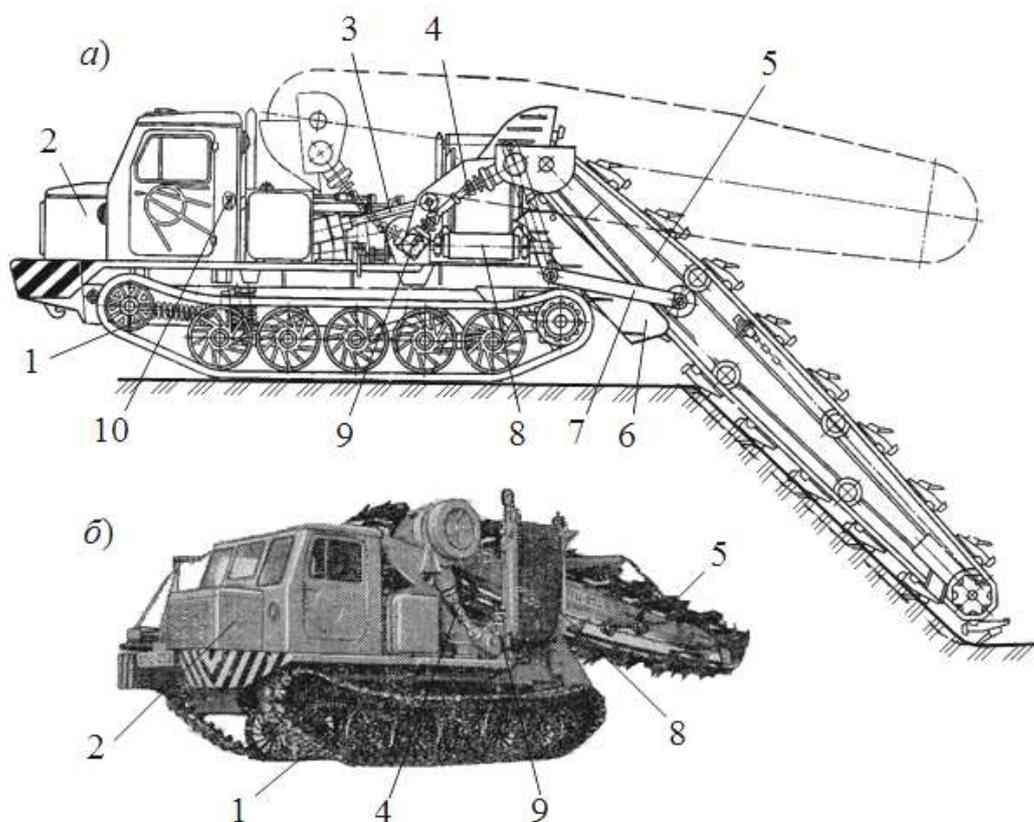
Траншейные цепной экскаватор: а - конструктивная схема; б-общие вид; 1-гусеничный ход; 2-кабина; 3-гидроцилиндр для подъема и опускание рабочего органа; 4-карданная вал; 5- цепной рабочего органа; 6-жолоб; 7-вылка; 8-поперечный транспортер; 9-угловой редуктор; 10-безступенчатие регулировычные механизм.
